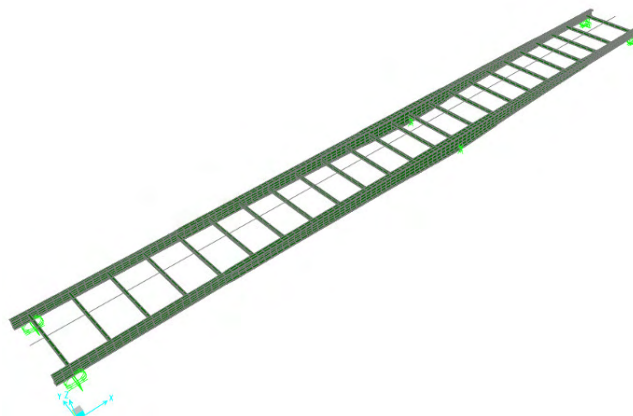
Modelo final dos contraventamentos ao longo das vigas longitudinais.
